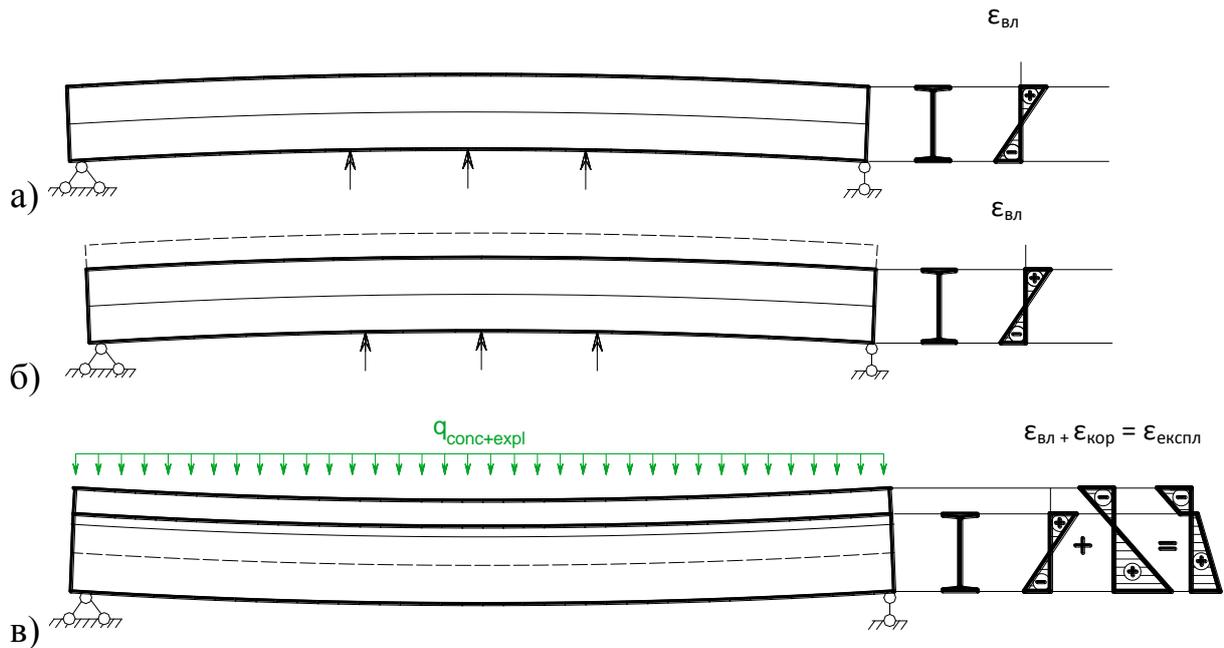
Стадії роботи комбінованого попередньо напруженого сталезалізобетонного перекриття: а) монтаж сталевих балок та створення їх попереднього вигину; б) влаштування монолітного залізобетонного перекриття при наявності тимчасових стійок під сталевими балками; в) експлуатаційна стадія
